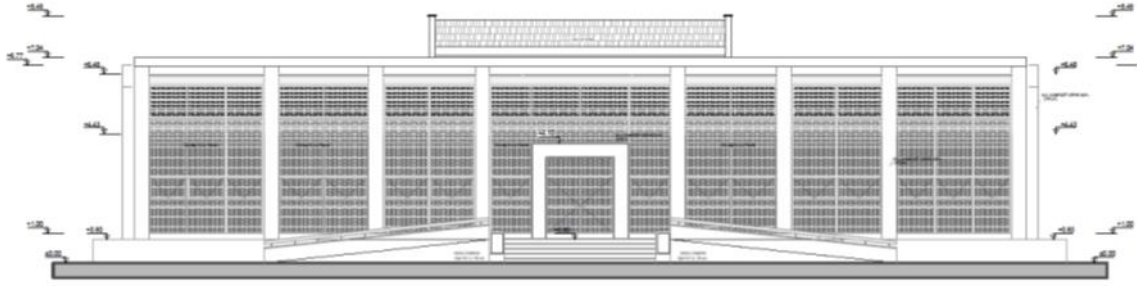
Bina plan şemasını yansıtan kütle biçimlenişi
